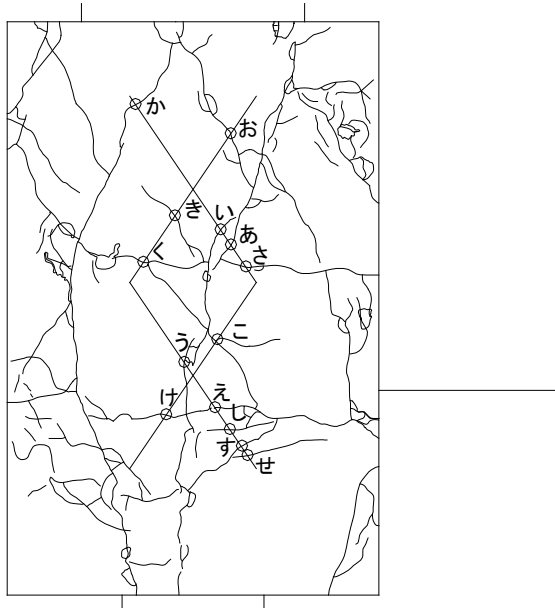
パイルキャップひび割れ幅測定位置 (試験体 A-4 負荷荷)
